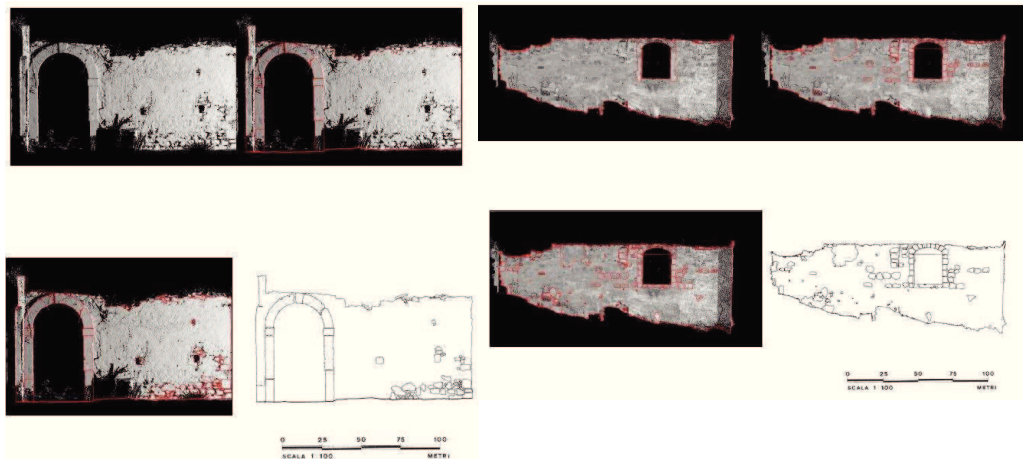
San Lorenzo Vecchio. Ortofoto da modello triangolarizzato di parte del prospetto interno alla corte, lato nord e restituzione finale (restituzioni di Laura Privitera).
